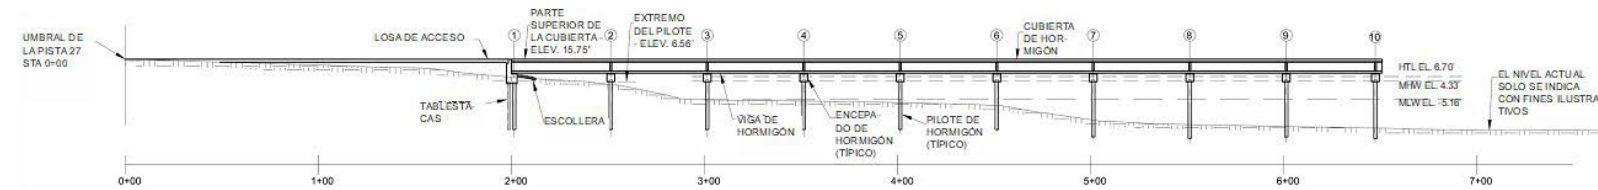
Alternativa 2 para el soporte de la cubierta de la RSA
